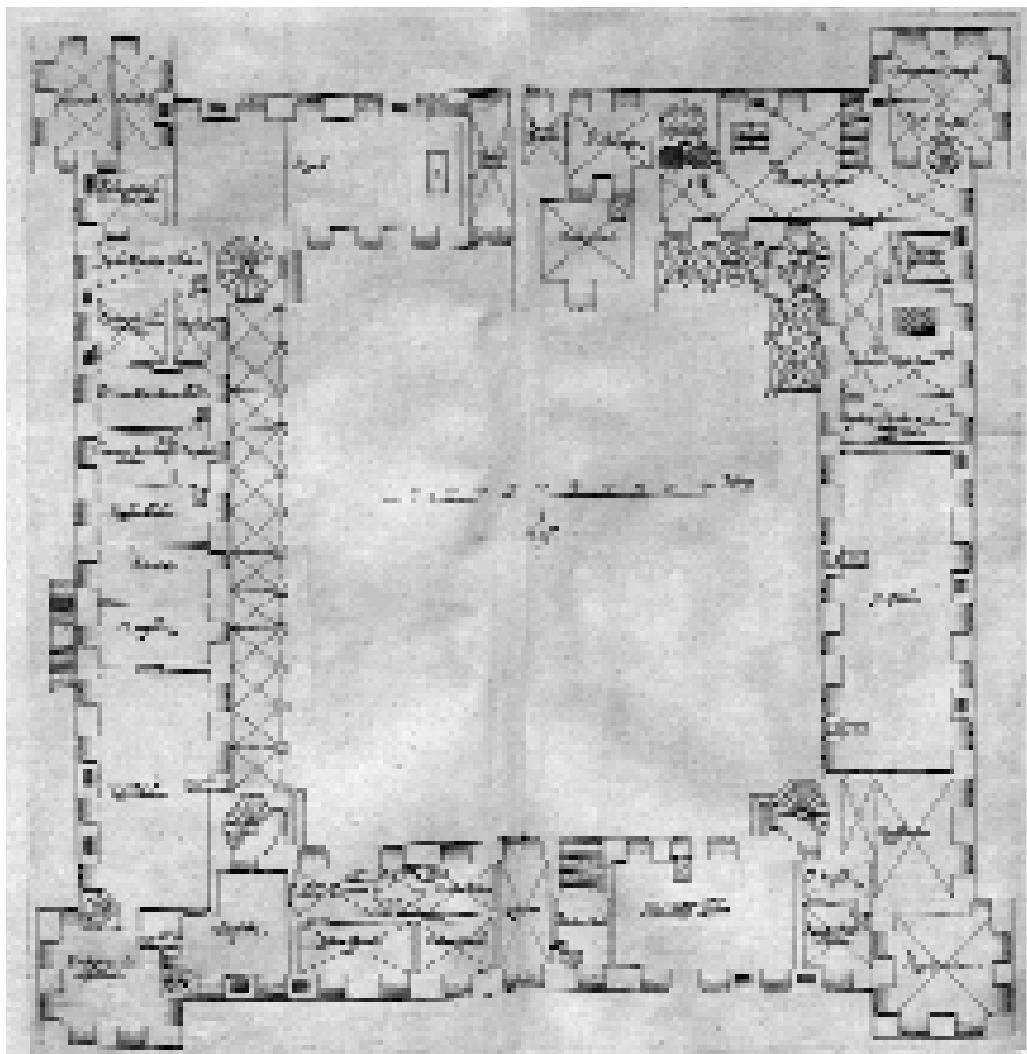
Georg Ridinger, Aschaffenburg, Schloss, orthogonaler Erdgeschossgrundriss, 1616
